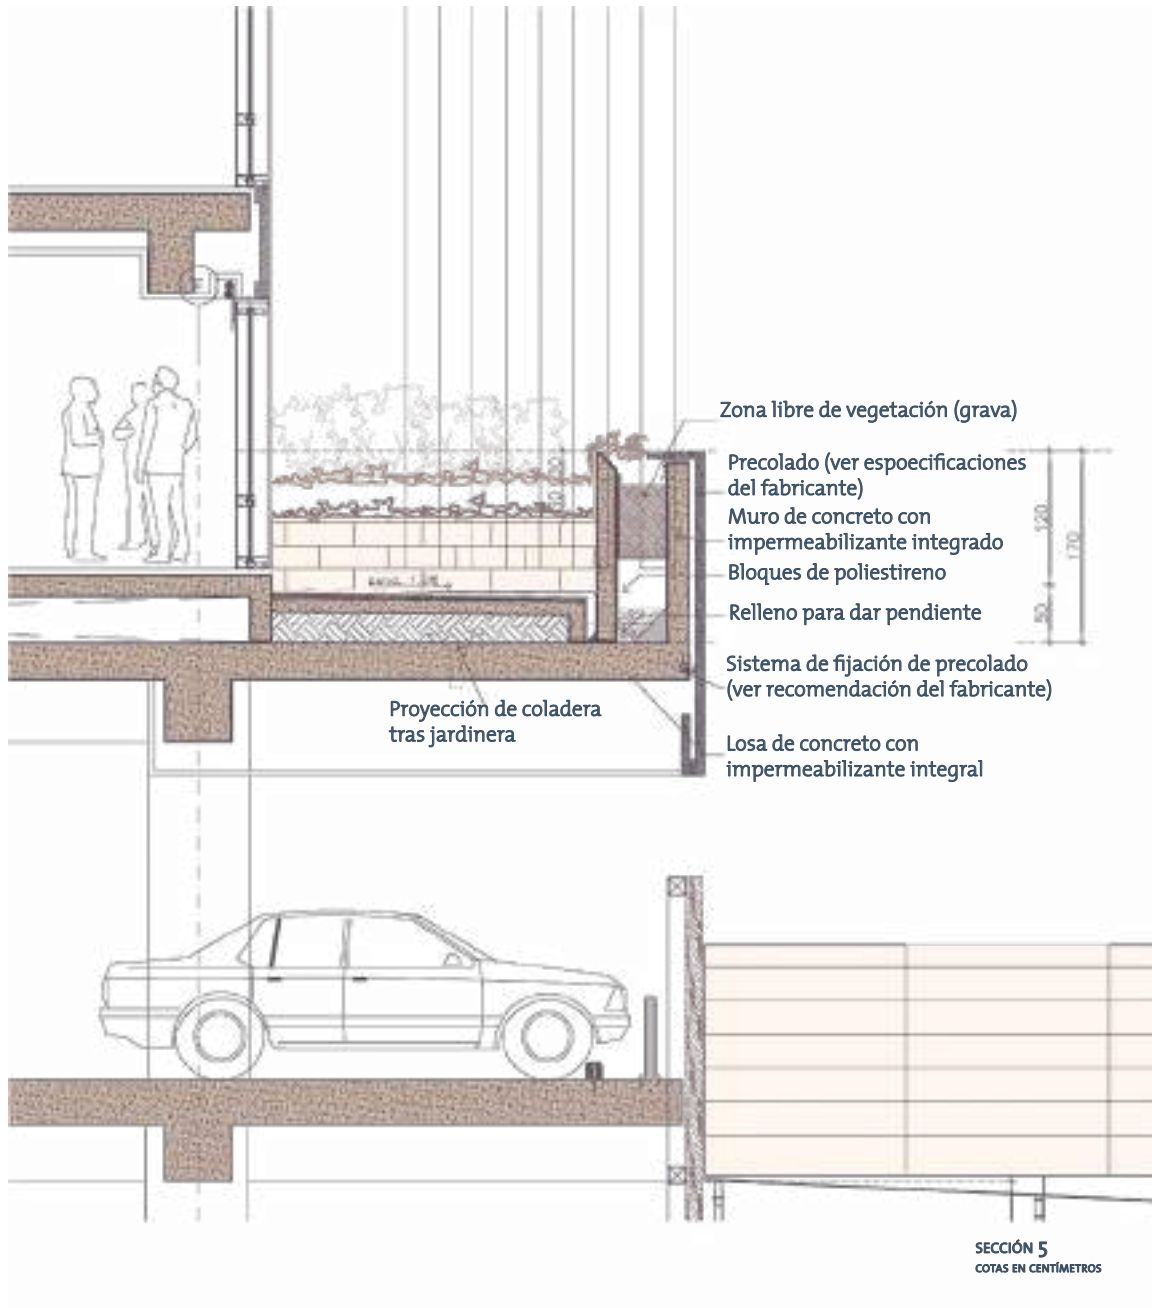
Detalles de jardineras sobre estructura, conjunto Miyana, Polanco, Ciudad de México
